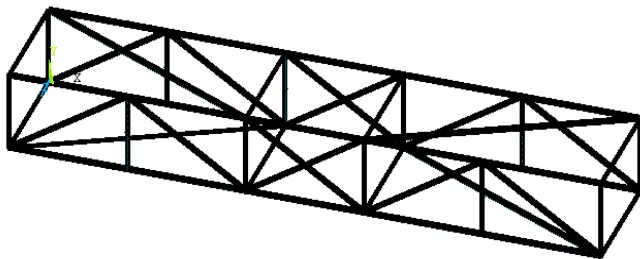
Просторова ферма для розміщення підсиленої циліндричної оболонки
